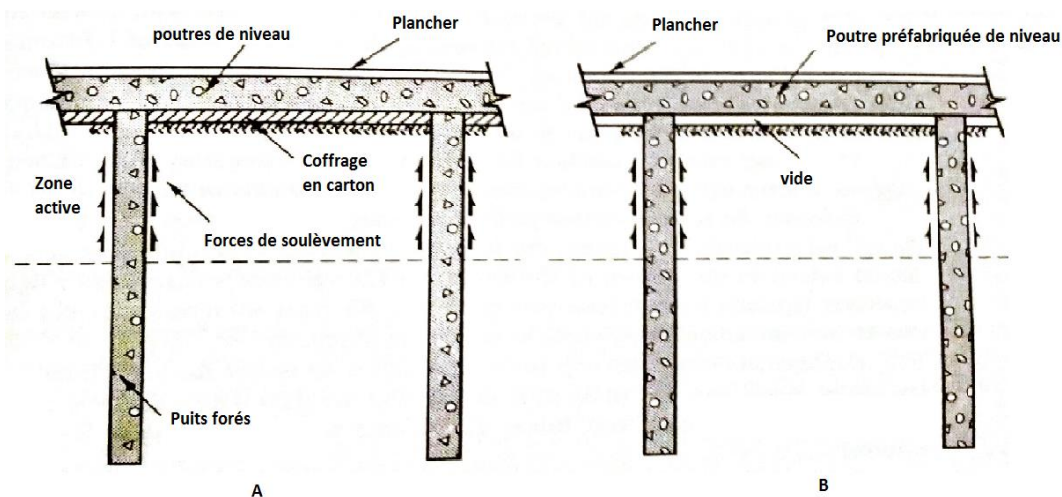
Fondation de bâtiment légère typique composée de puits forés et de poutres longrines (Coduto, 1994).
